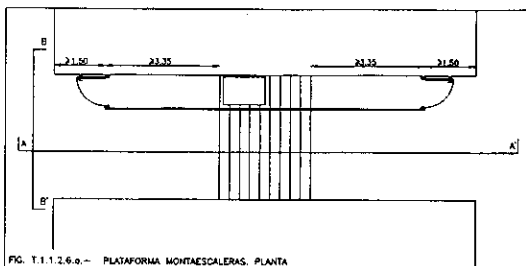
a.- PLATAFORMA MONTAESCALERAS, PLANTA
